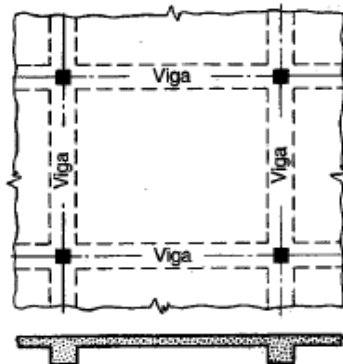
Losa perimetralmente apoyada (Nilson 2001)
